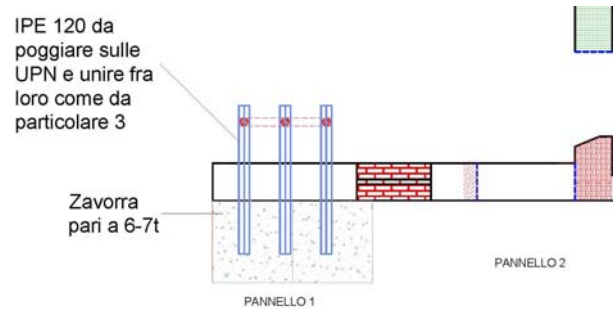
Il sistema di contrasto; planimetria di riferimento parete A.
